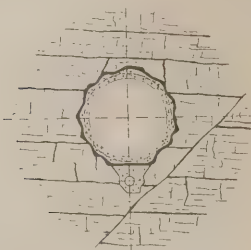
Horizontalquerschnitt durch einen Steigschacht in standfestem Gebirge unter Ausschluß von äußerem Wasserdruck. Drainage bleibt offen.
